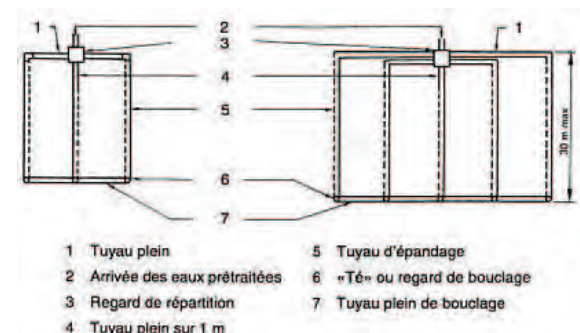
Vues en plan ; exemples à 3 et 5 tranchées
